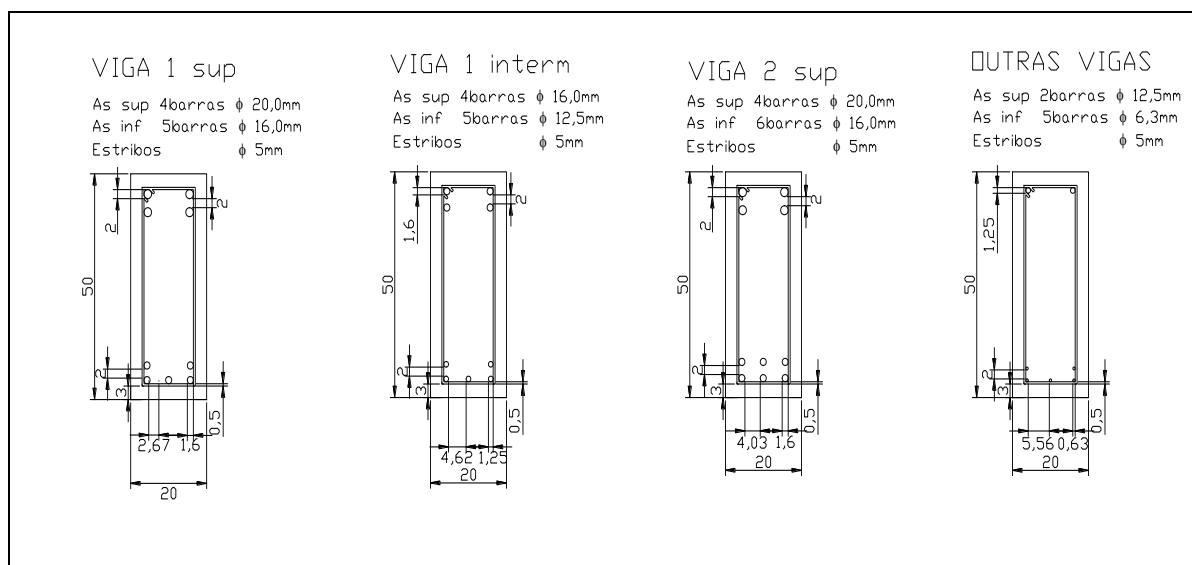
Exemplo: detalhamento da ST das vigas, com detalhes das armaduras.
